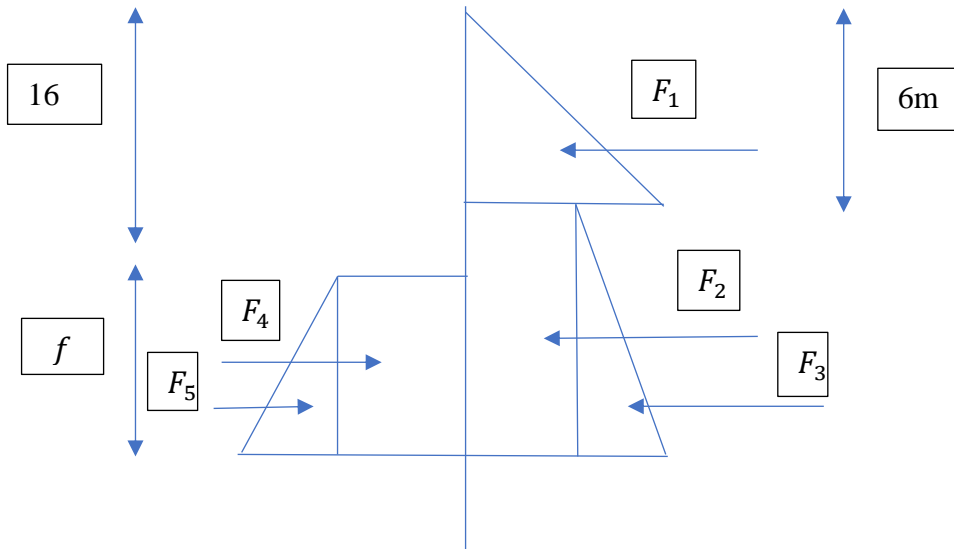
Présentations des pressions appliquées sur la palplanche cas profondeur d’excavation 16m
